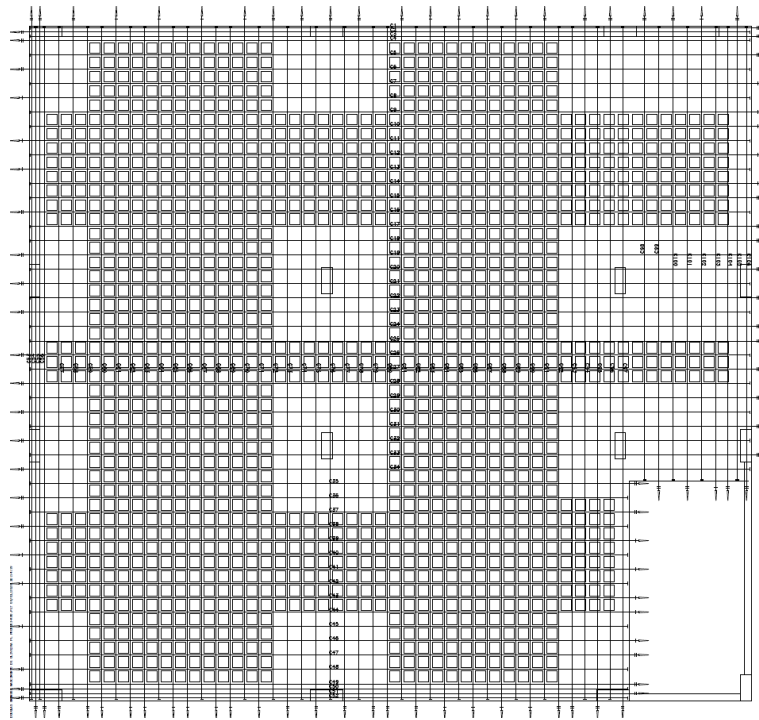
Projeto C2 – Distribuição das cordoalhas de protensão em planta.
